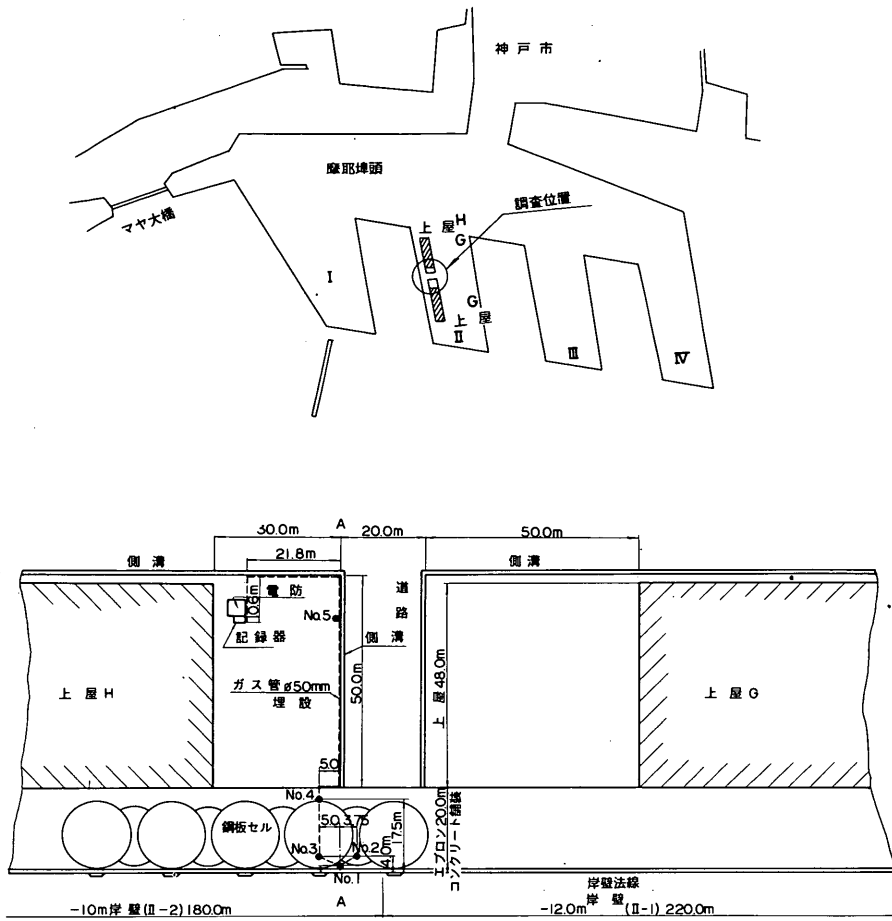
(a) 神戸港摩耶埠頭平面図および測定管配置図
